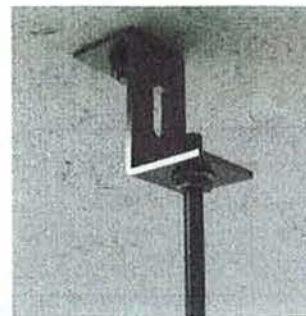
Detalle de fijación al techo de un soporte para bandeja.
